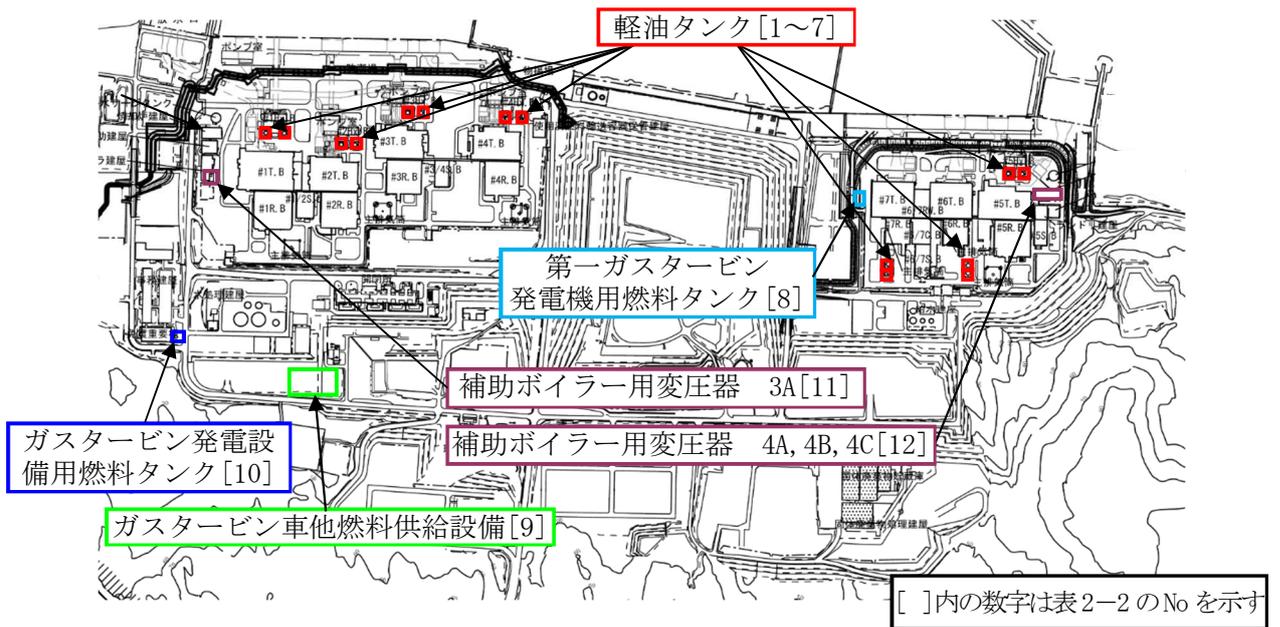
発電所敷地内に設置する危険物タンク等施設の配置図
